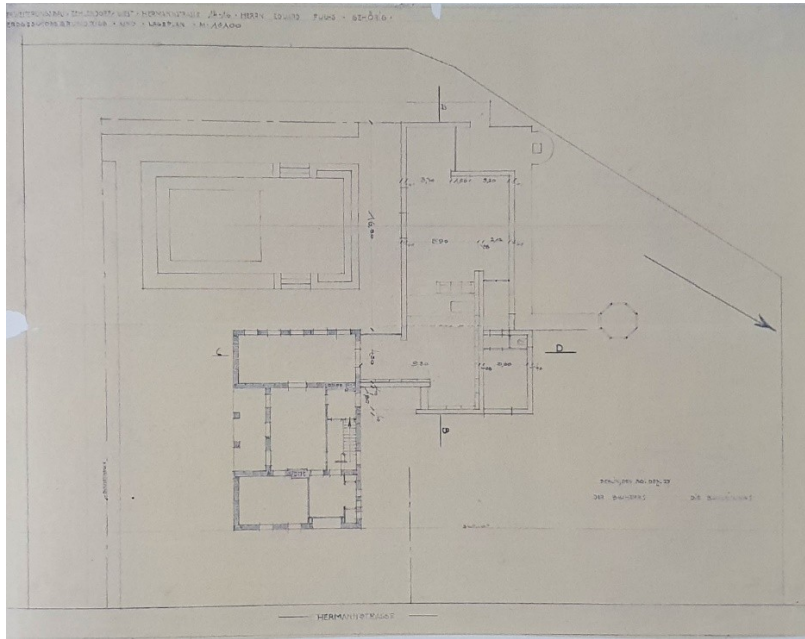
Planta baixa com projeto de expansão, Casa Perls, 1927.
